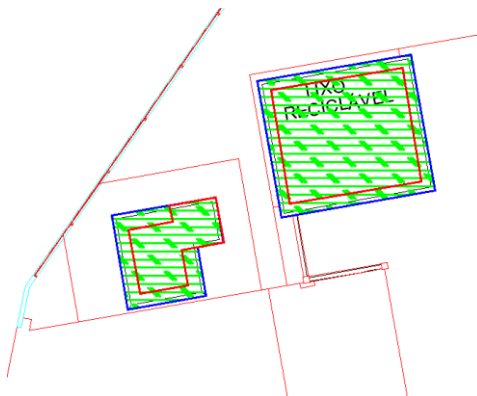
Área considerada para pavimento final (Guarita 1 e Lixo)
